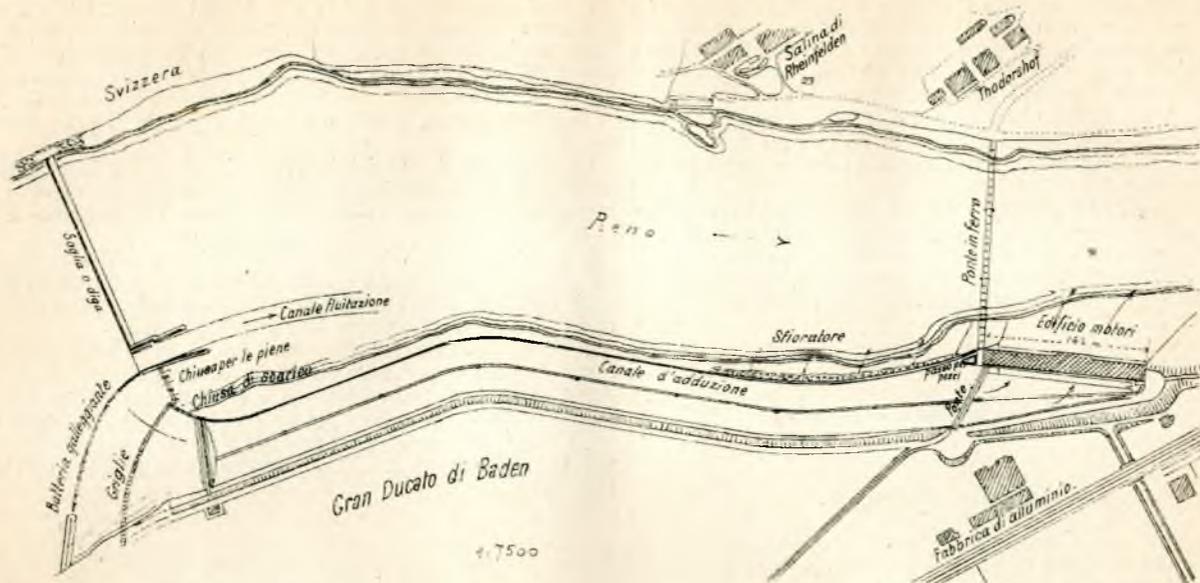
Impianto di Rheinfelden. — Planimetria.
